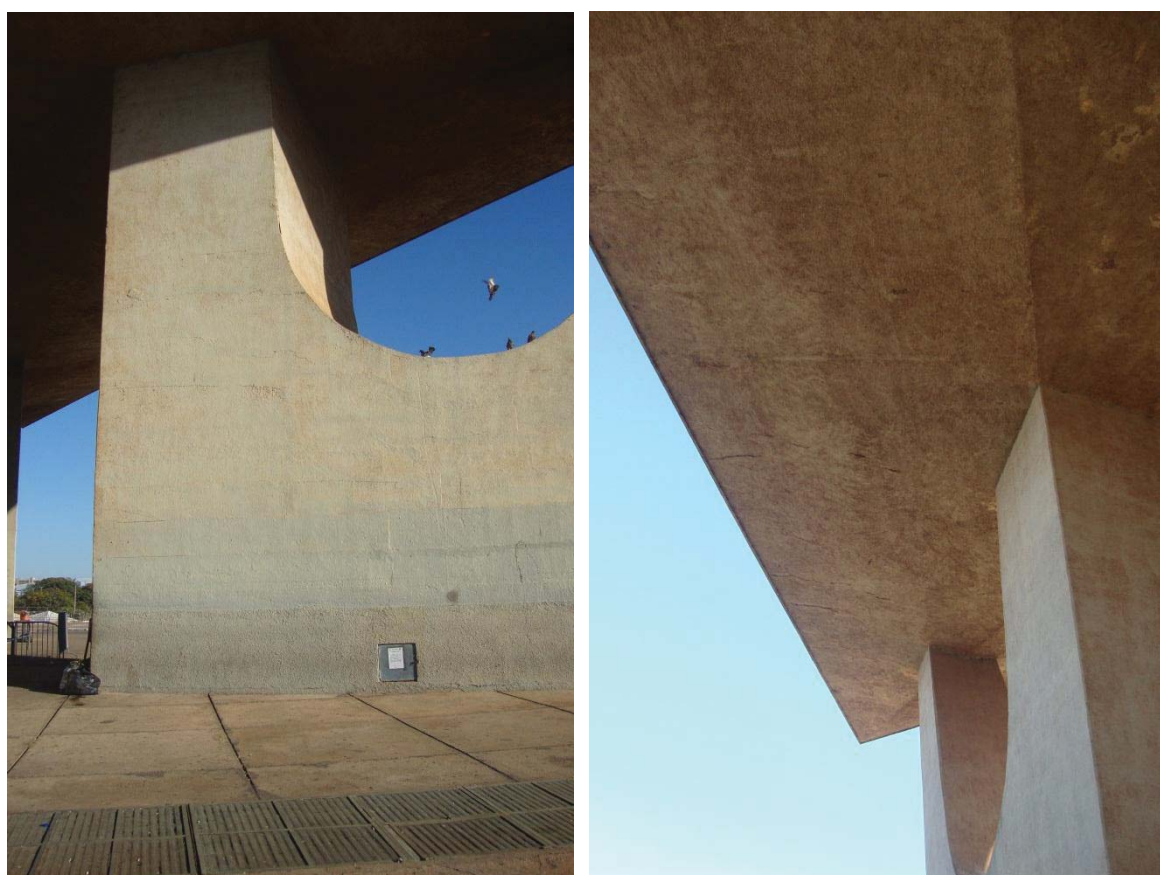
Detalhe dos Pilares de Concreto Armado no Térreo (Fonte: Autor)
